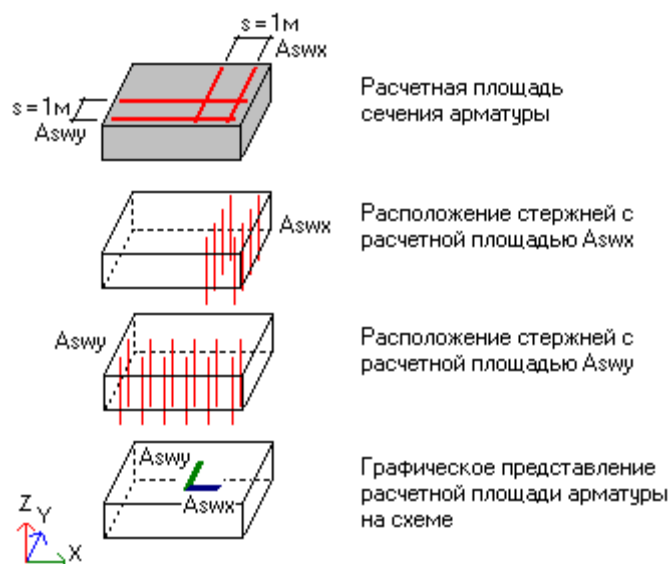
Обозначения расчетной площади поперечного армирования
